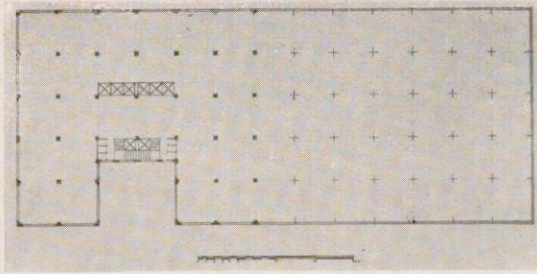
Chicago Tribune, Grundriß S. Abb. 17
